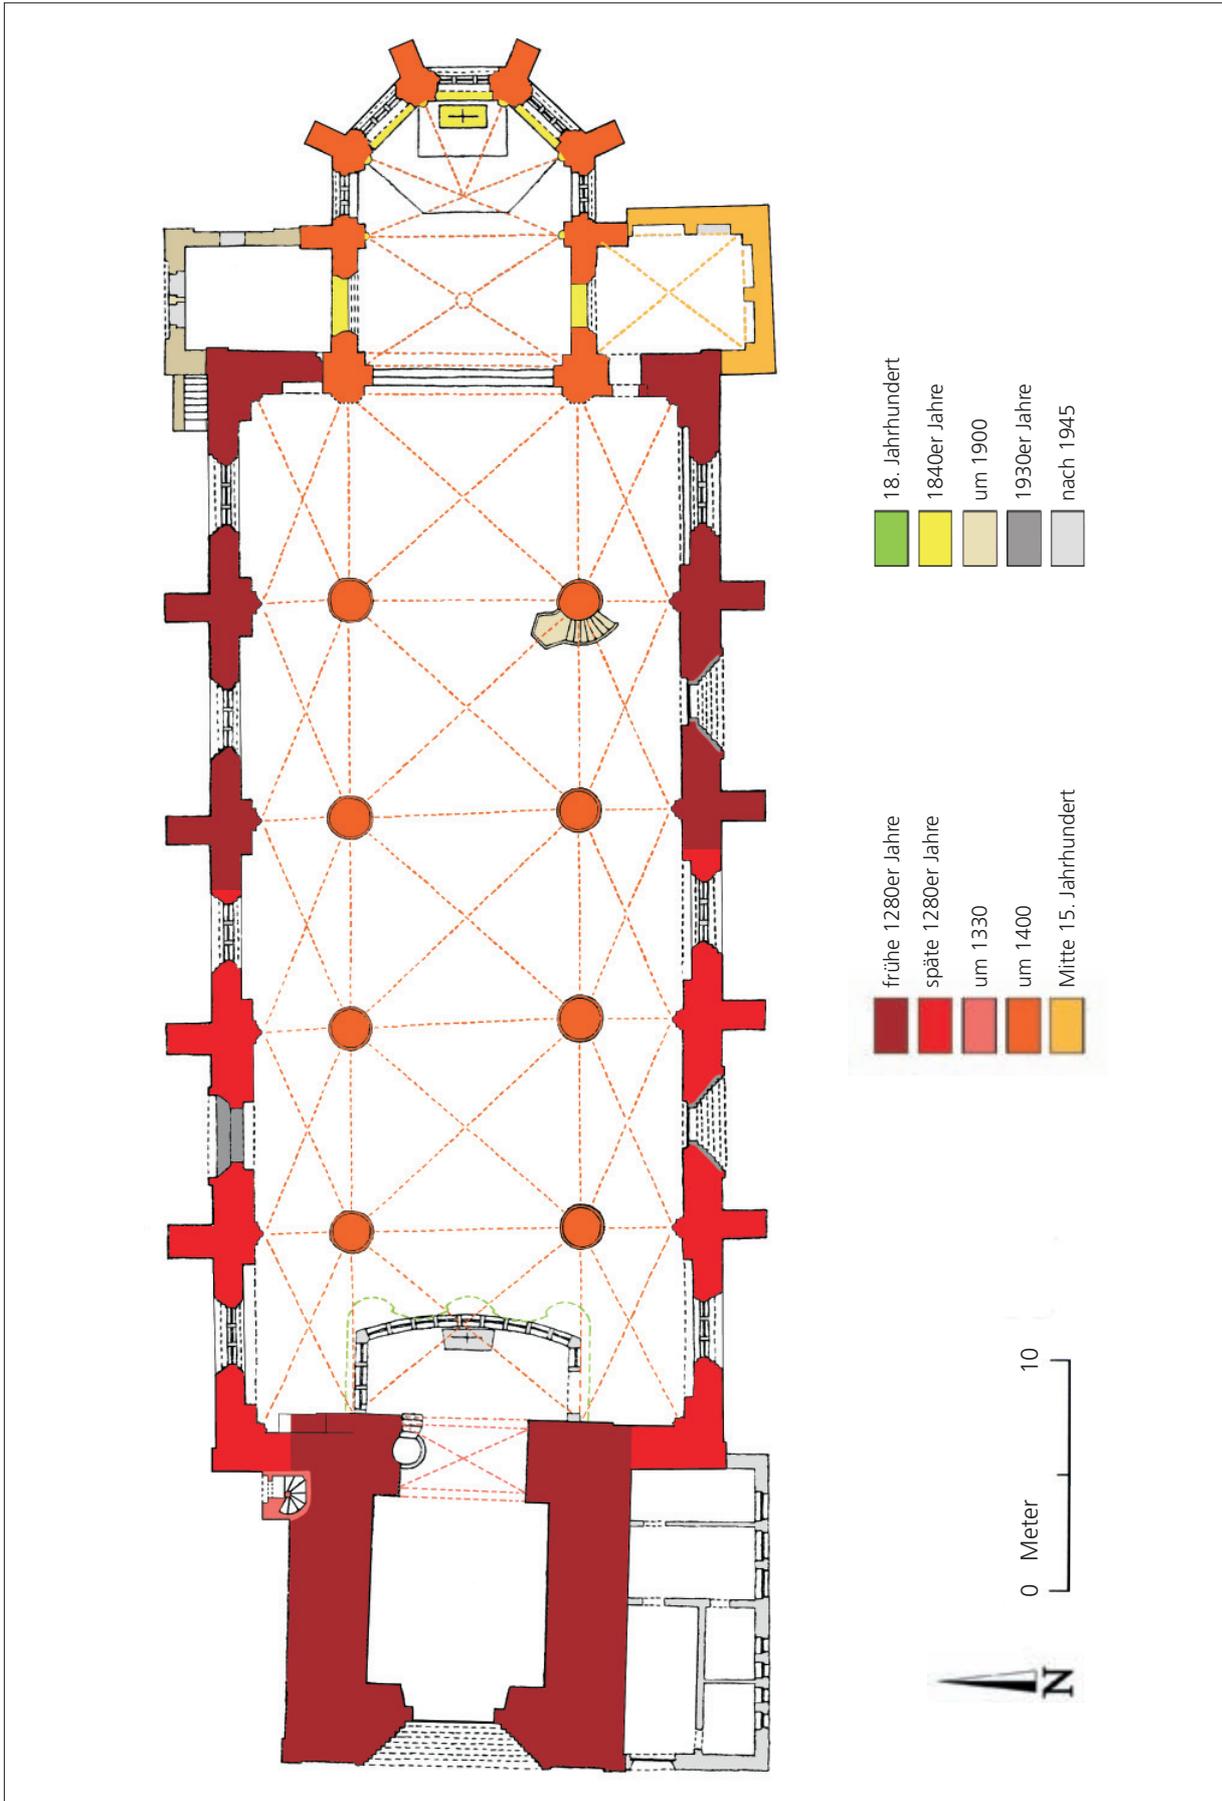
St. Jacobi, Grundriss mit der Kartierung der wichtigsten Bauphasen
